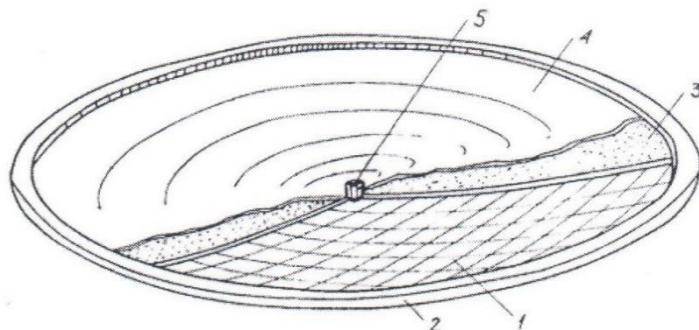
Конструктивная схема покрытия круглого в плане из переплетенных лент. 1 - плетеная мембрана; 2 - опорный контур; 3 – утеплитель; 4 - гидроизоляционный ковер; 5 - водоприемная воронка
